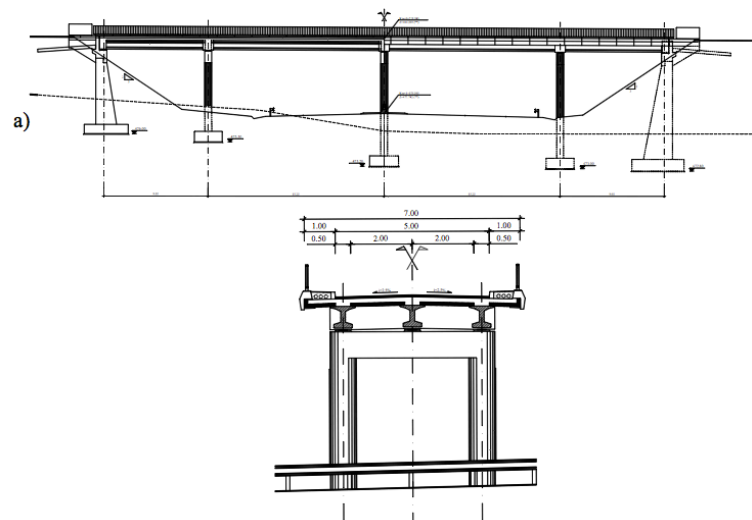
Solução de vigas em I usada na auto-estrada da Beira Interior
